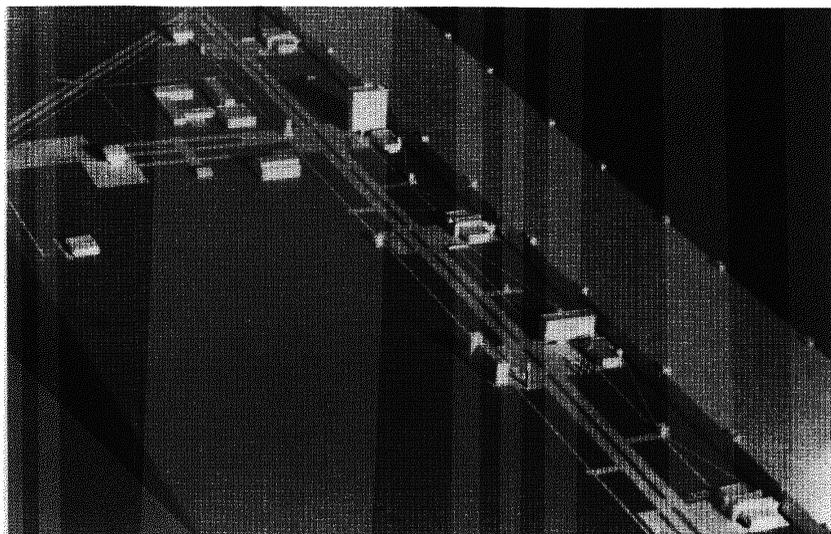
Абаканский вагоностроительный завод. Главный корпус и комплекс зданий предзаводской зоны (предложение ЦНИИПромзданий)
